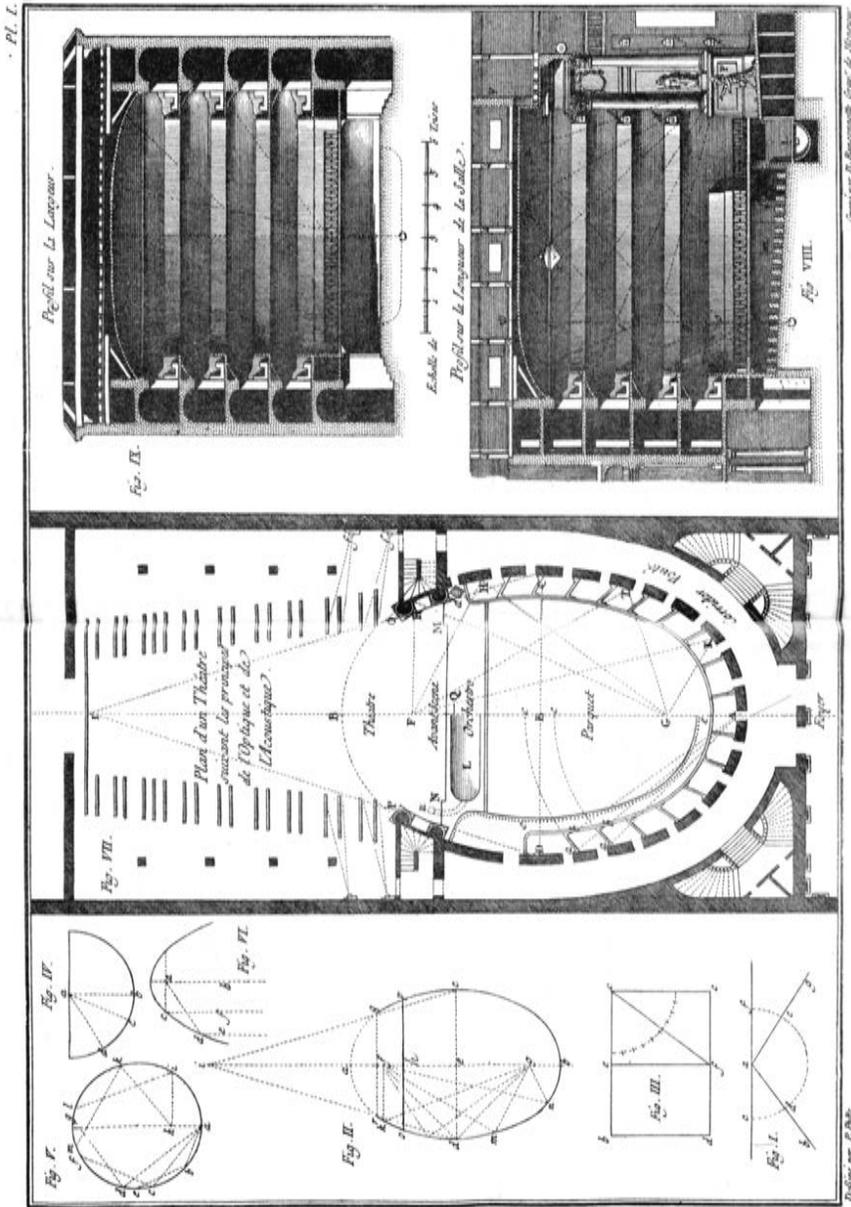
Pierre PATTE, *Plan d'un Théâtre suivant les principes de l'Optique et de l'Acoustique*, pianta, sezioni e grafici (da P. PATTE, *Essai sur l'Architecture Théâtrale...*, Paris 1782).
